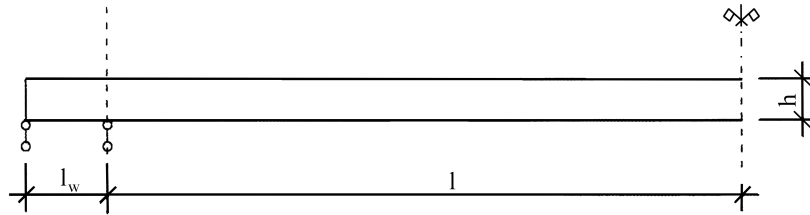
Model zamocowania belki wspornikowej w bloku betonowym
